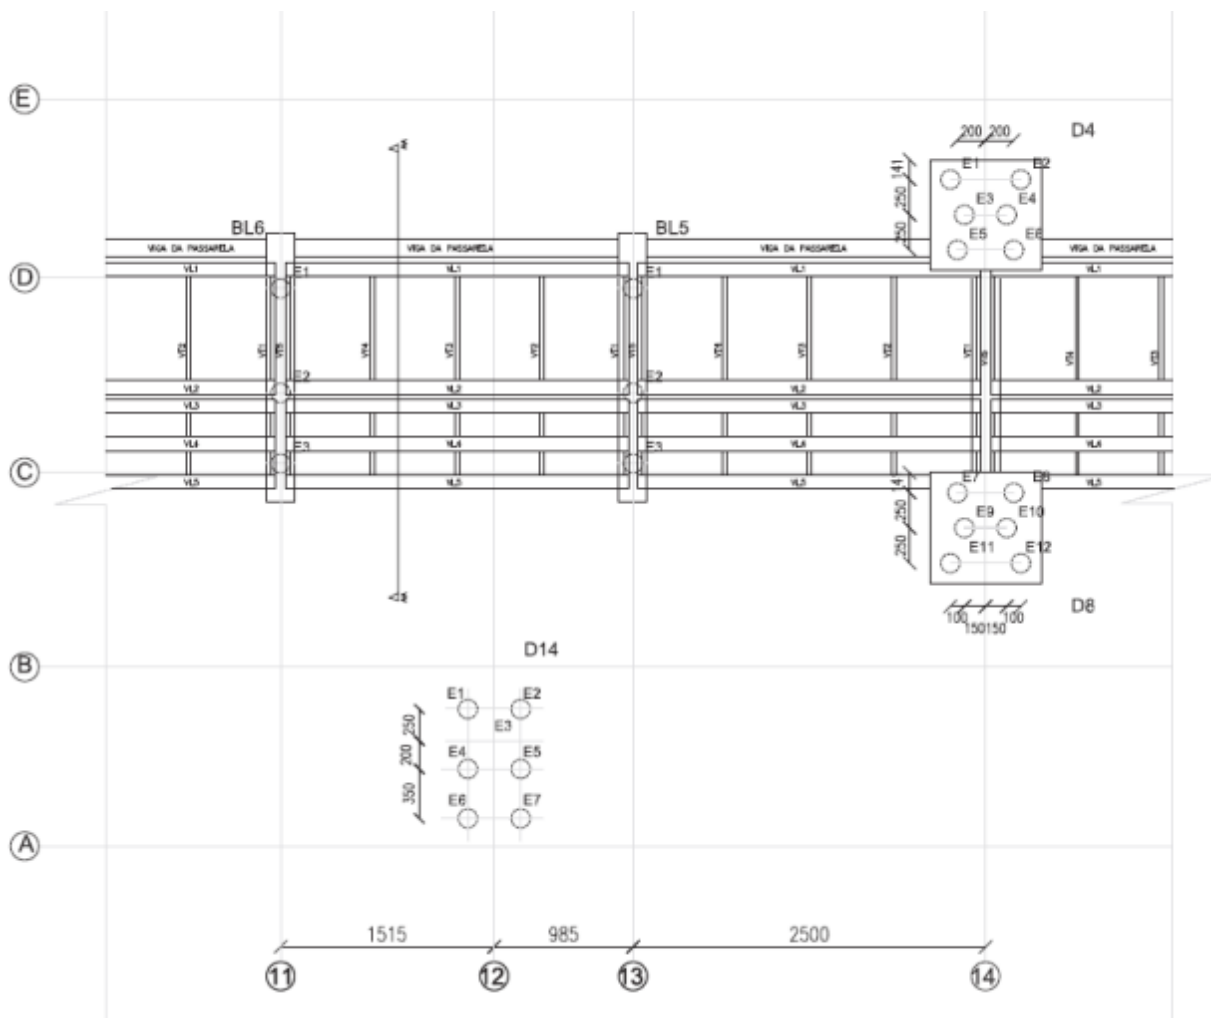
Planta dos Vãos 5, 6, 7 e 8 da Ponte de Acesso do Berço 106
